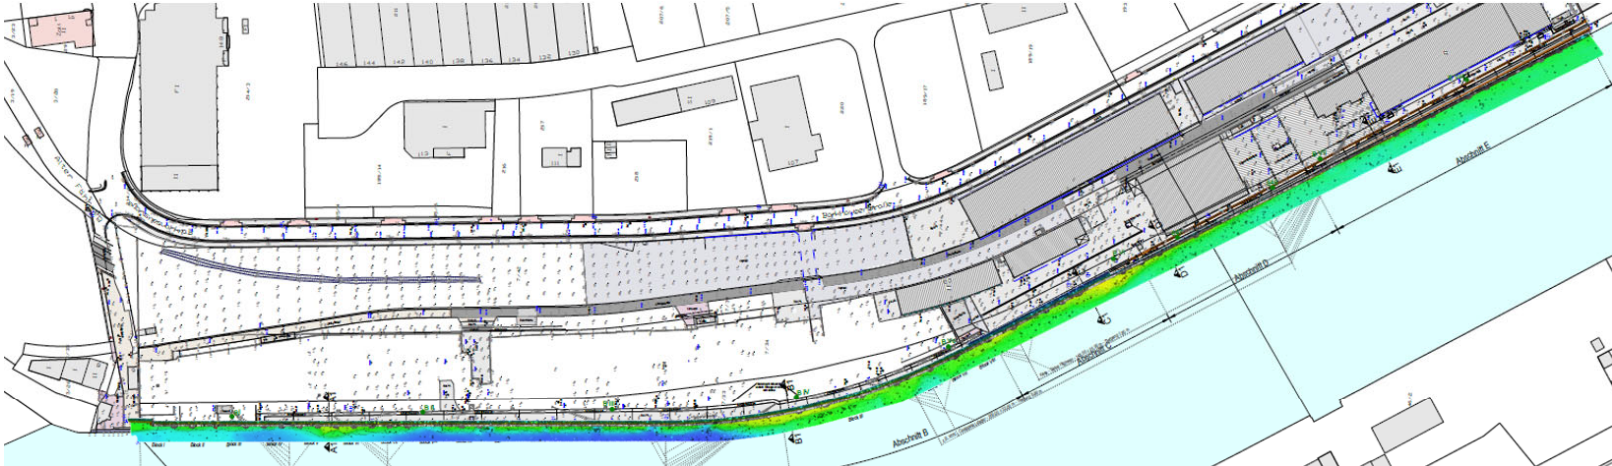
Schadensverdachtsstelle 2 – Detailsicht
